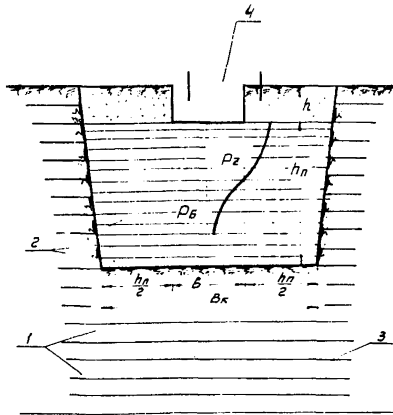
Схема к расчету уплотнения основания при устройстве в верхней части лессовой толщи "подушки" из переработанного грунта:
